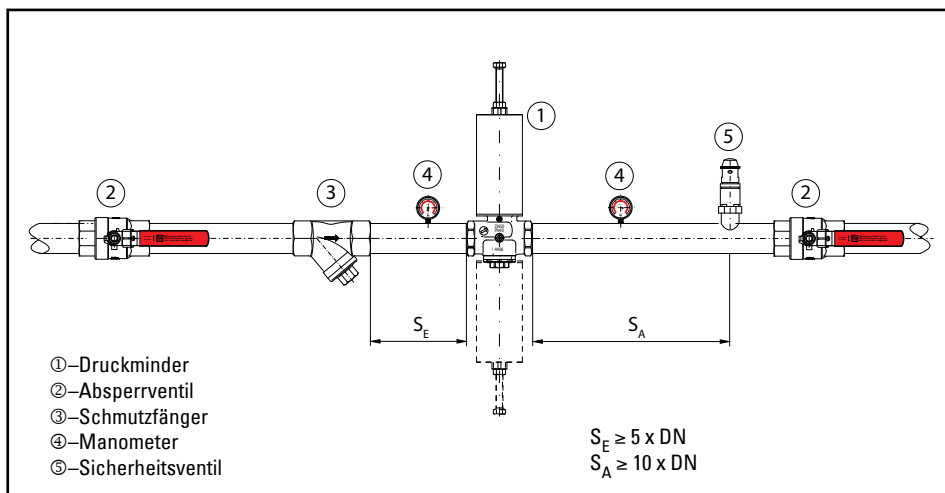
Druckminderer, Einbauschema Druckminderer
